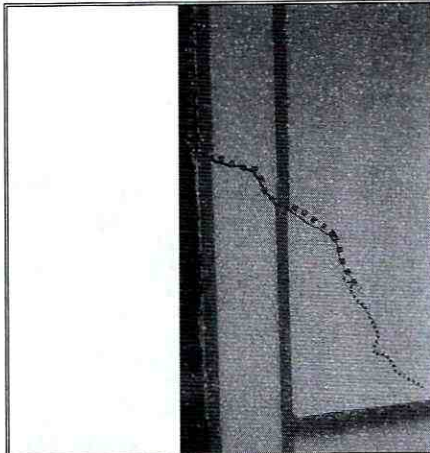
Vista de las fisuras del Carrera 68G No 65-68
